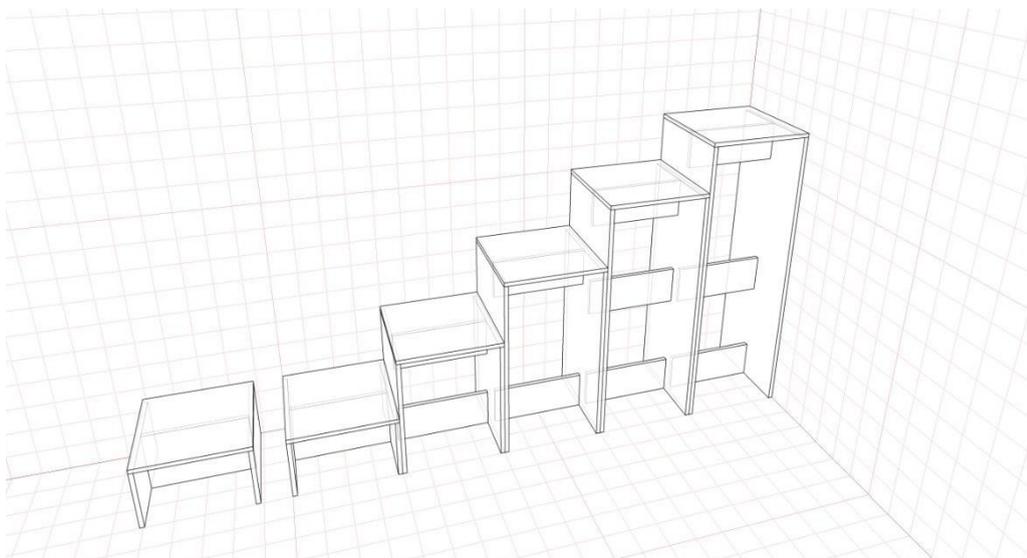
Образцы смотровых площадок (без мостовых перекрытий)
